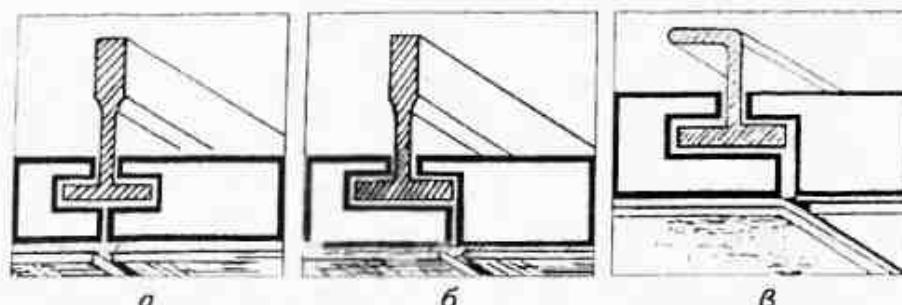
Основной несущий профиль: а — крепящийся на черновой каркас видимой подвесной системы; б — крепящийся на черновой каркас невидимой подвесной системы; в — крепящийся к базовому потолку
